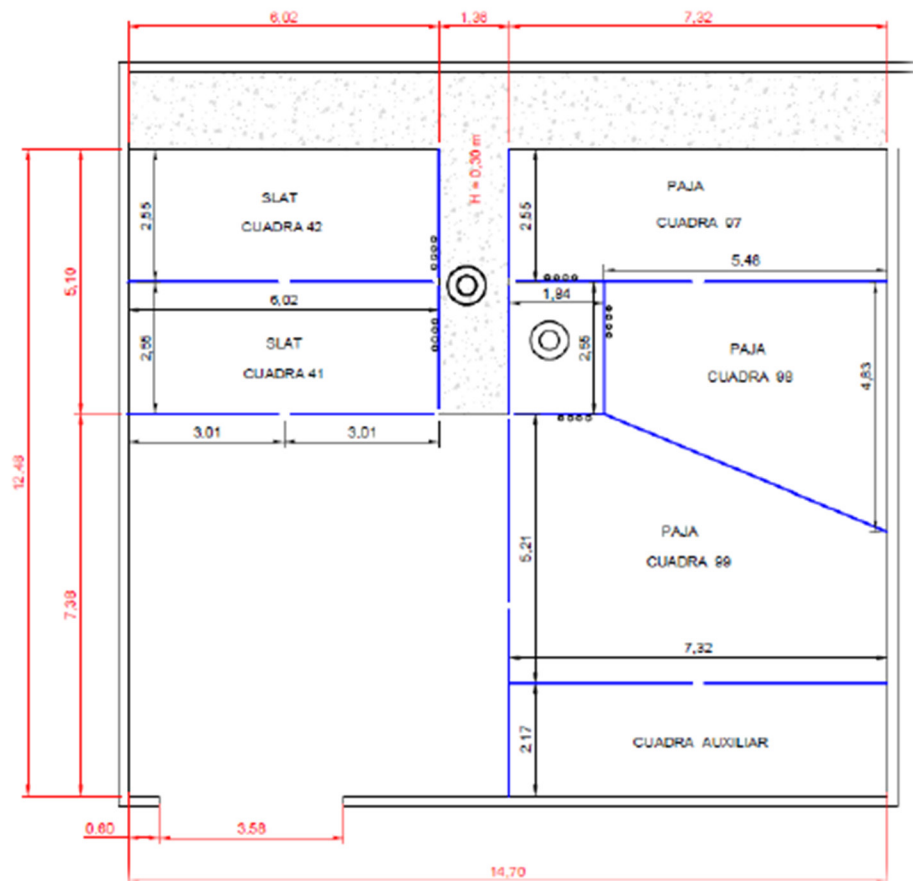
Esquema en planta de la nave de ensayo (cotas en m)
